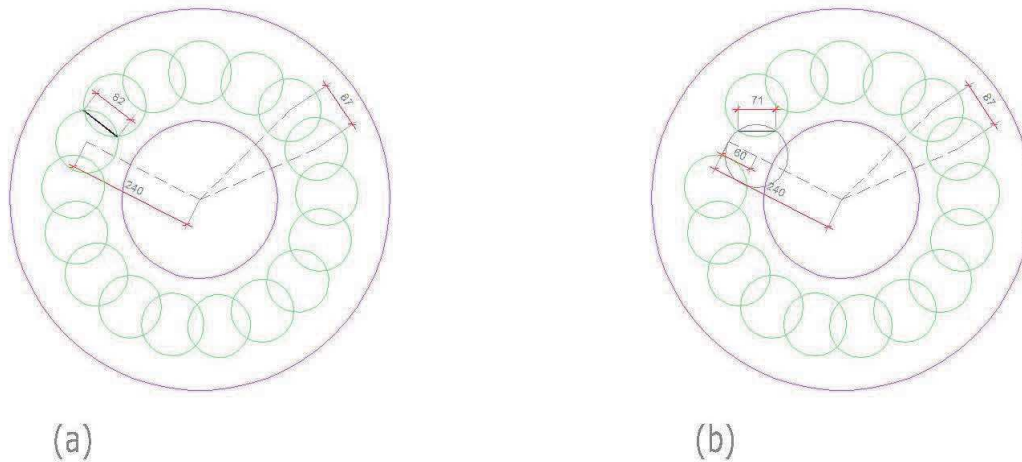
disposizione pali secanti dei pozzi di fondazione, con bordo plinto DN 7,2 m; e bordo Pila 3,0 m.
